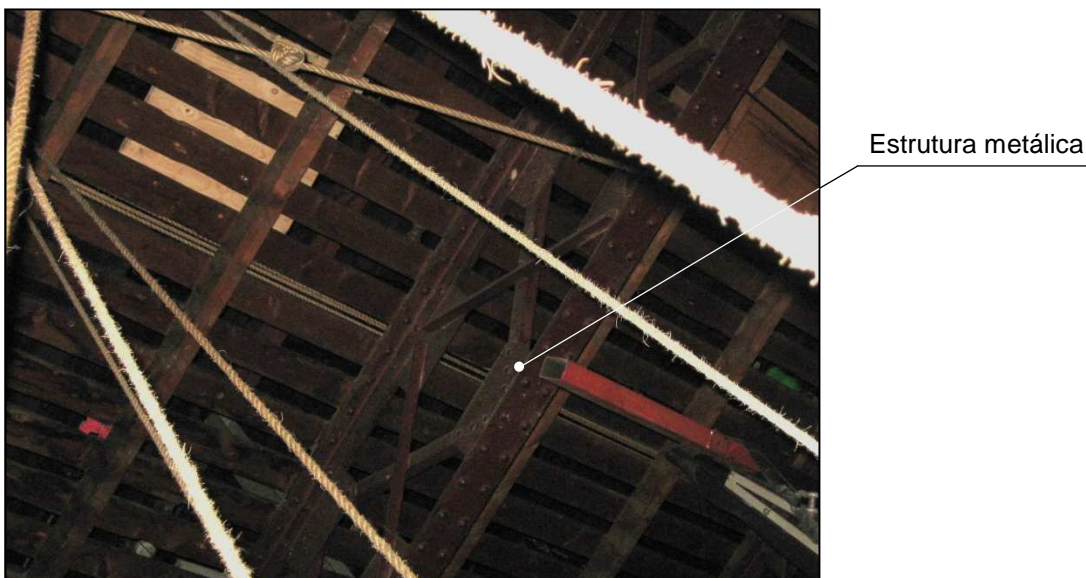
Estrutura metálica suportando pavimento em madeira
